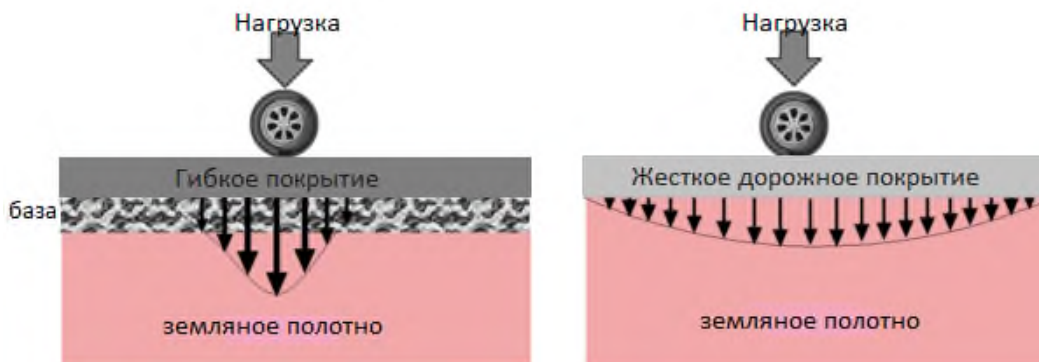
Действия автотранспортной нагрузки на асфальтобетонные и цементобетонные покрытия
